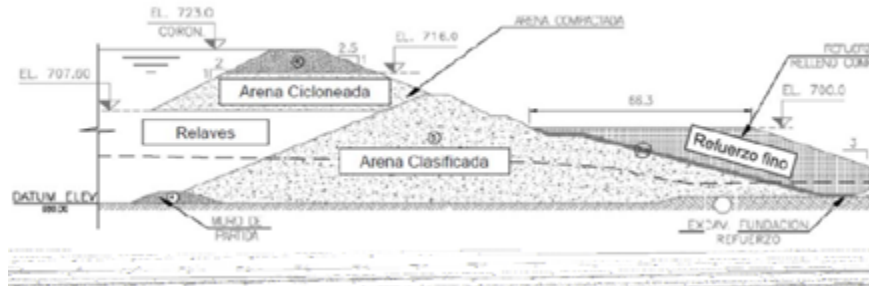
Sección transversal muro 3 del tranque Cauquenes
